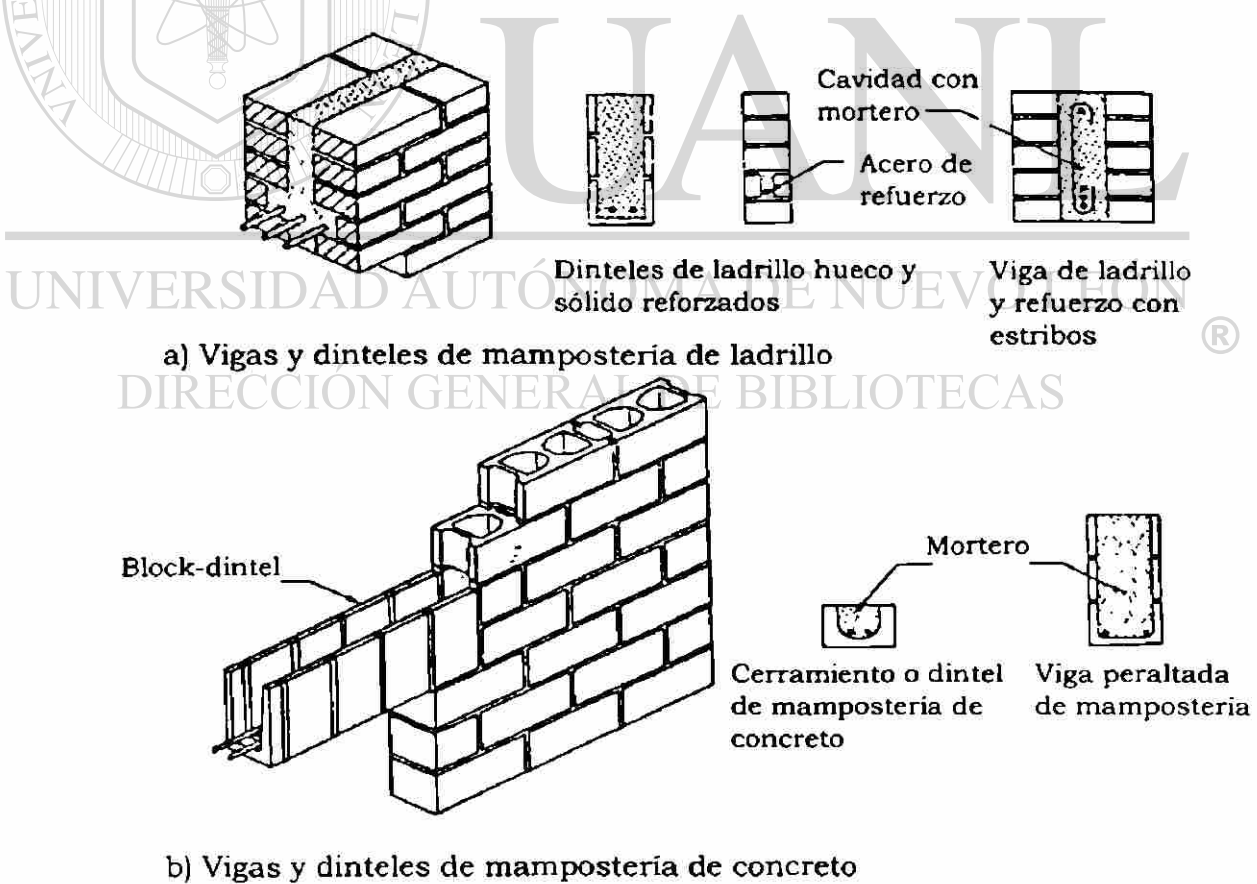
Arreglos comunes de vigas y dinteles de mampostería.
